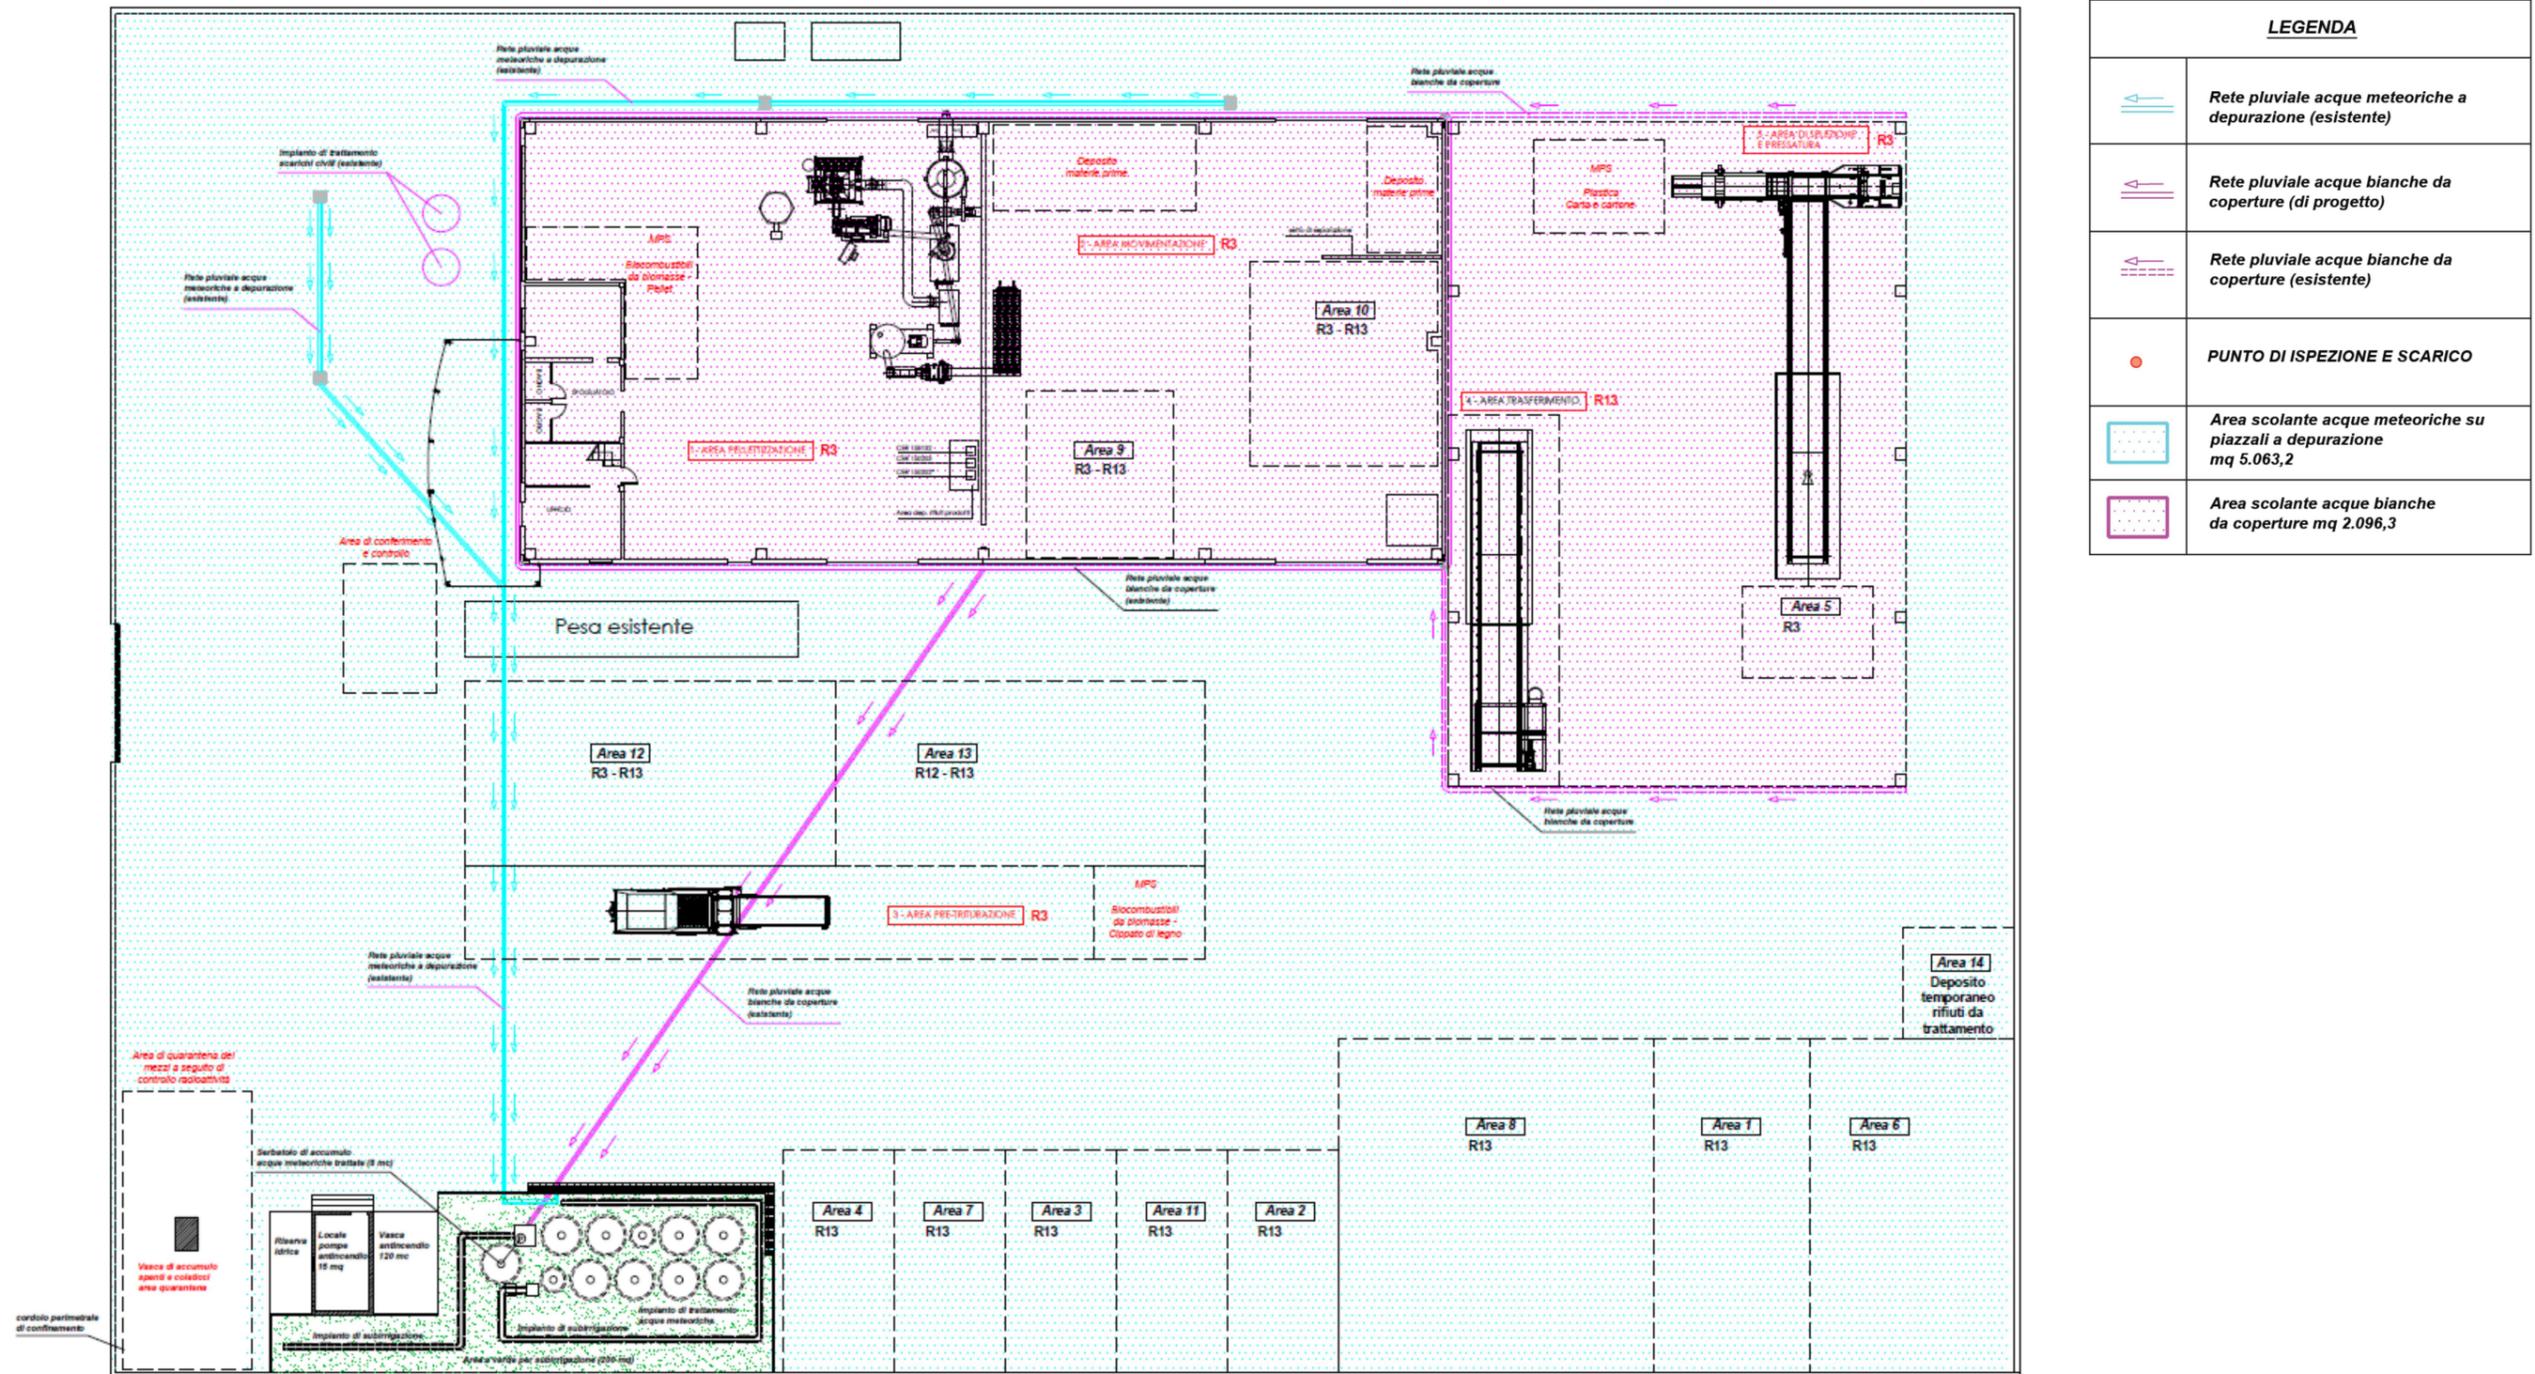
Planimetria reti acque piovane e indicazione dei punti di scarico
